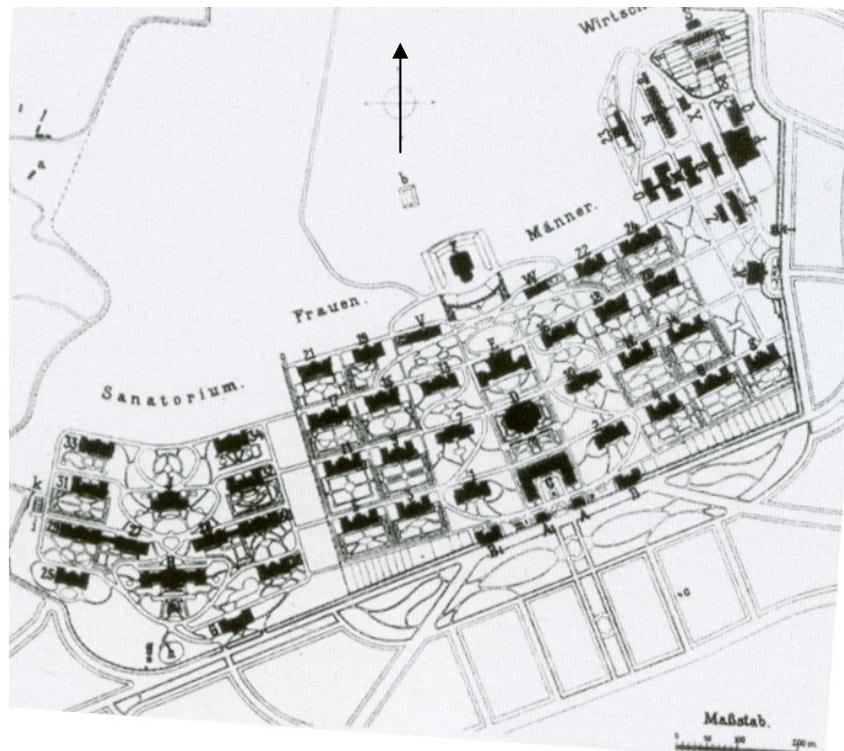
ENTWURF LAGEPLAN OTTO WAGNERS, 1902
